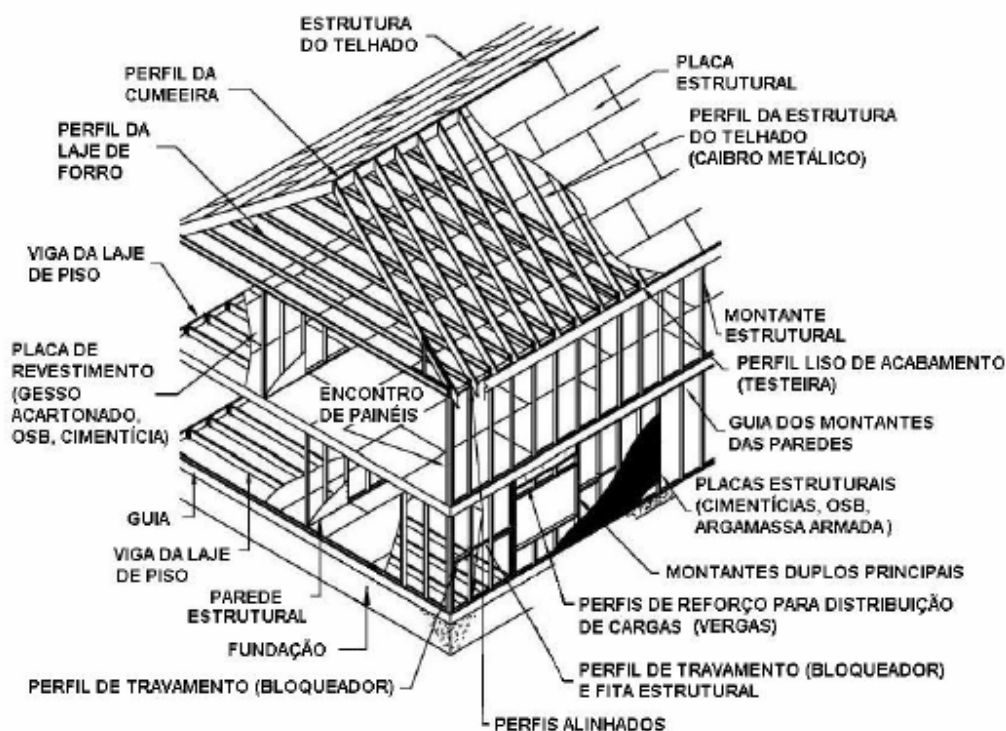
Desenho esquemático do sistema *steel framing*.
